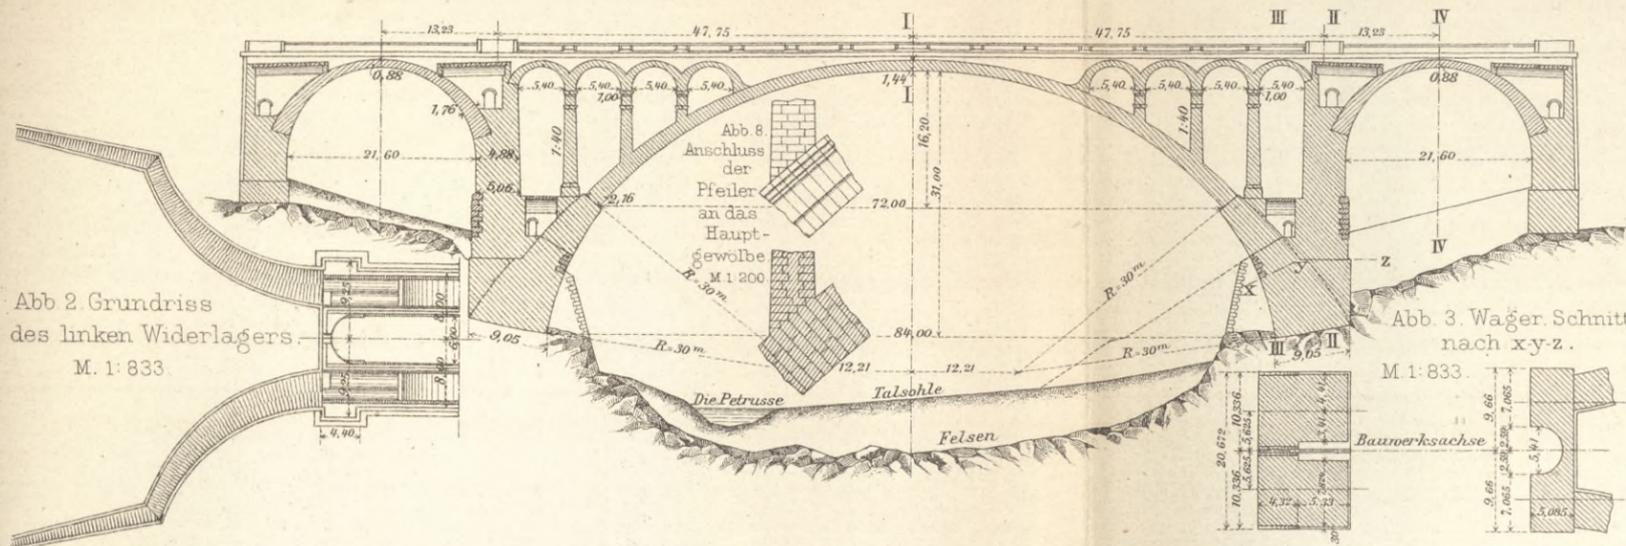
Grundriss des linken Widerlagers. M. 1: 833
